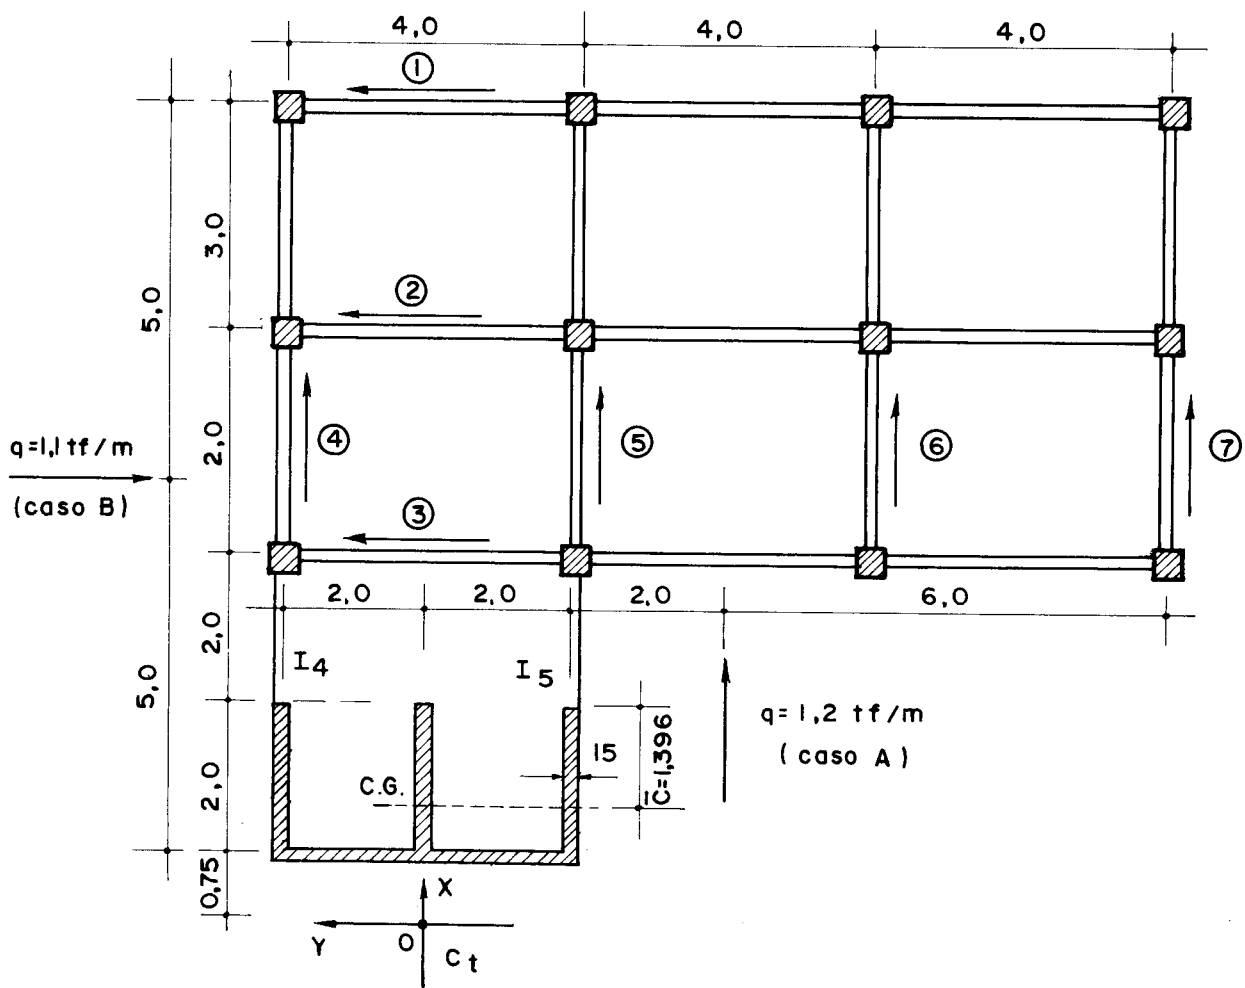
Estrutura em planta do quinto exemplo de aplicação
